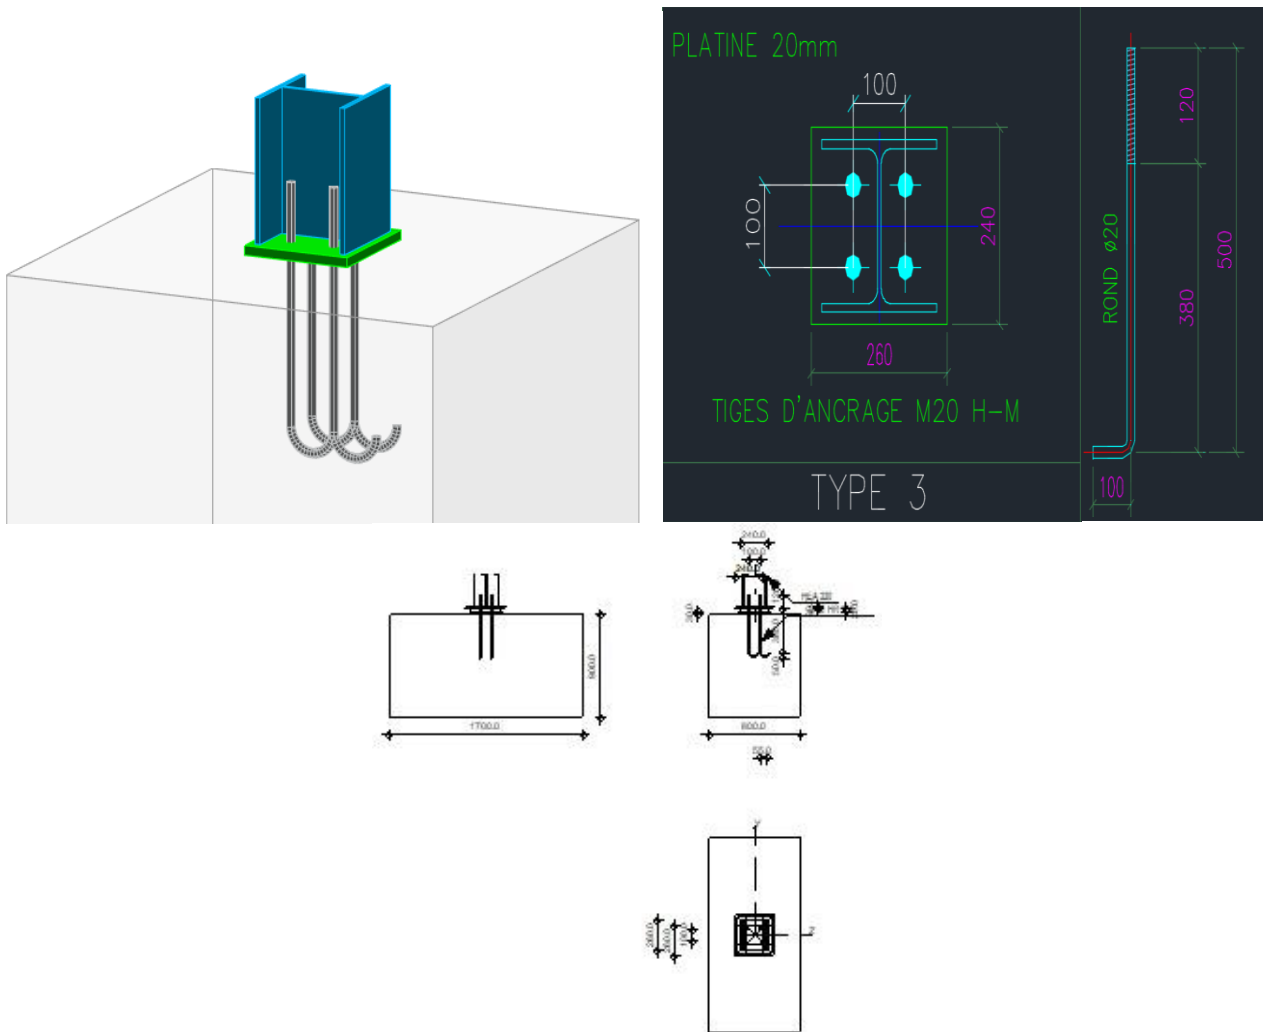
Schéma assemblage de pieds de poteau HEA220
